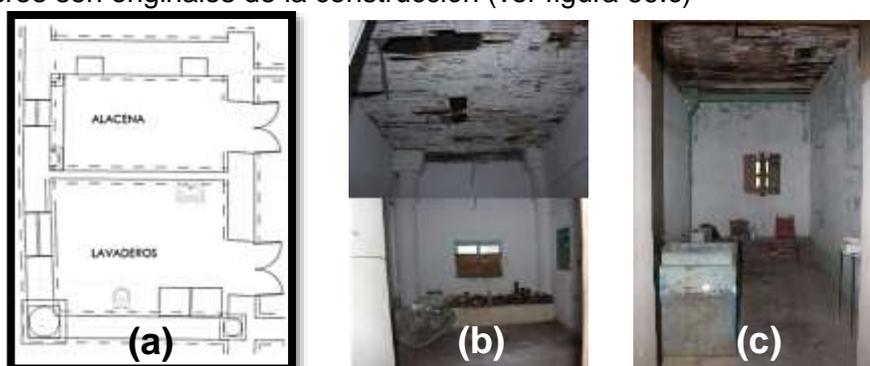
(a)Espacio analizado. (b)Vista de alacena y su falso plafón. (c) Vista de lavaderos.
